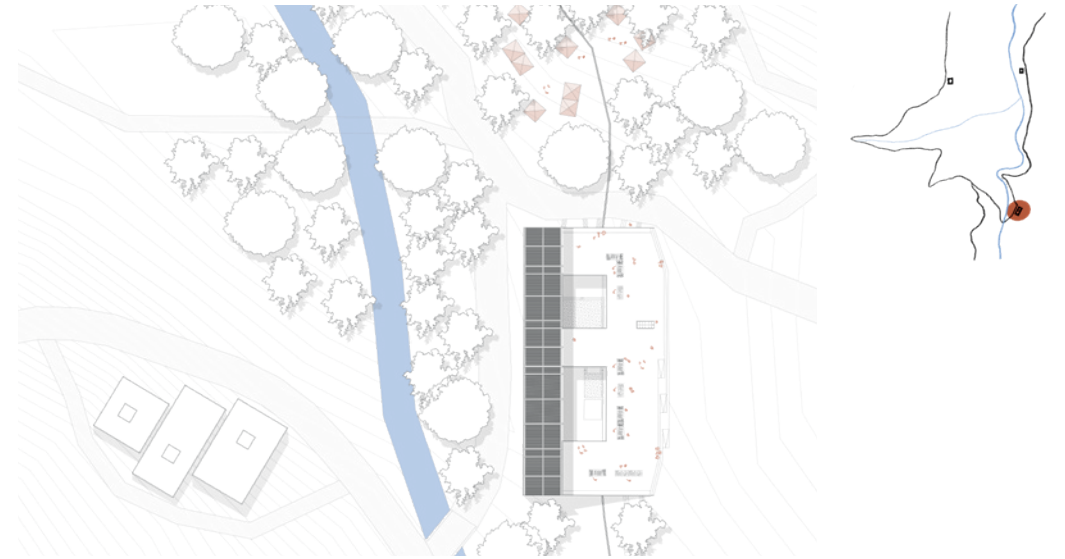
Plan masse Addouz, crédit de l'auteur.
